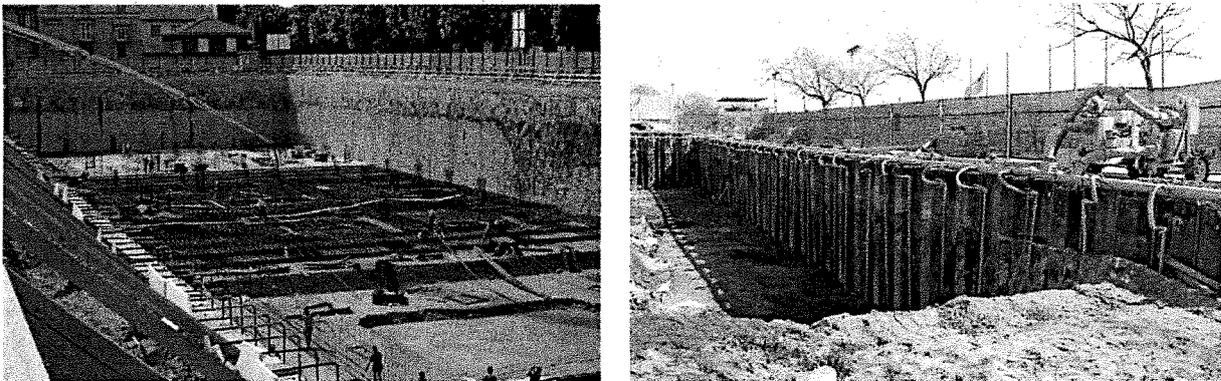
Scavo di fondazione ed esempio di sistema wellpoint
